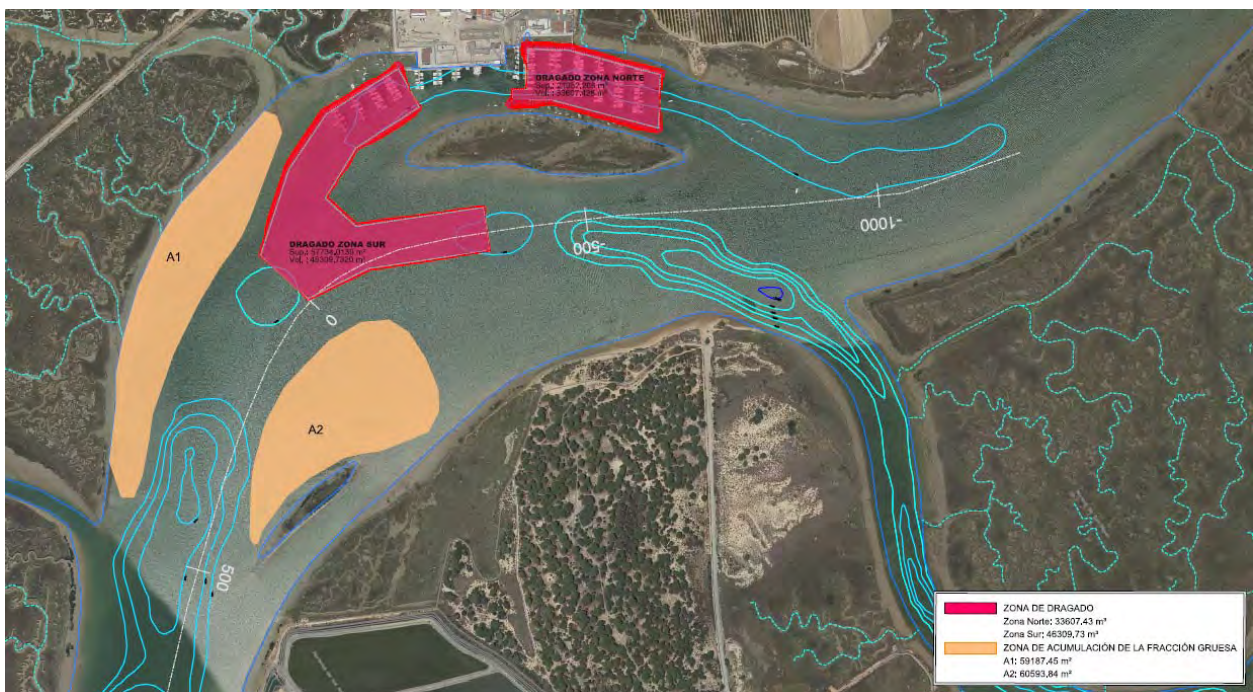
Planta de la propuesta de dragado en el puerto de El Terrón.
